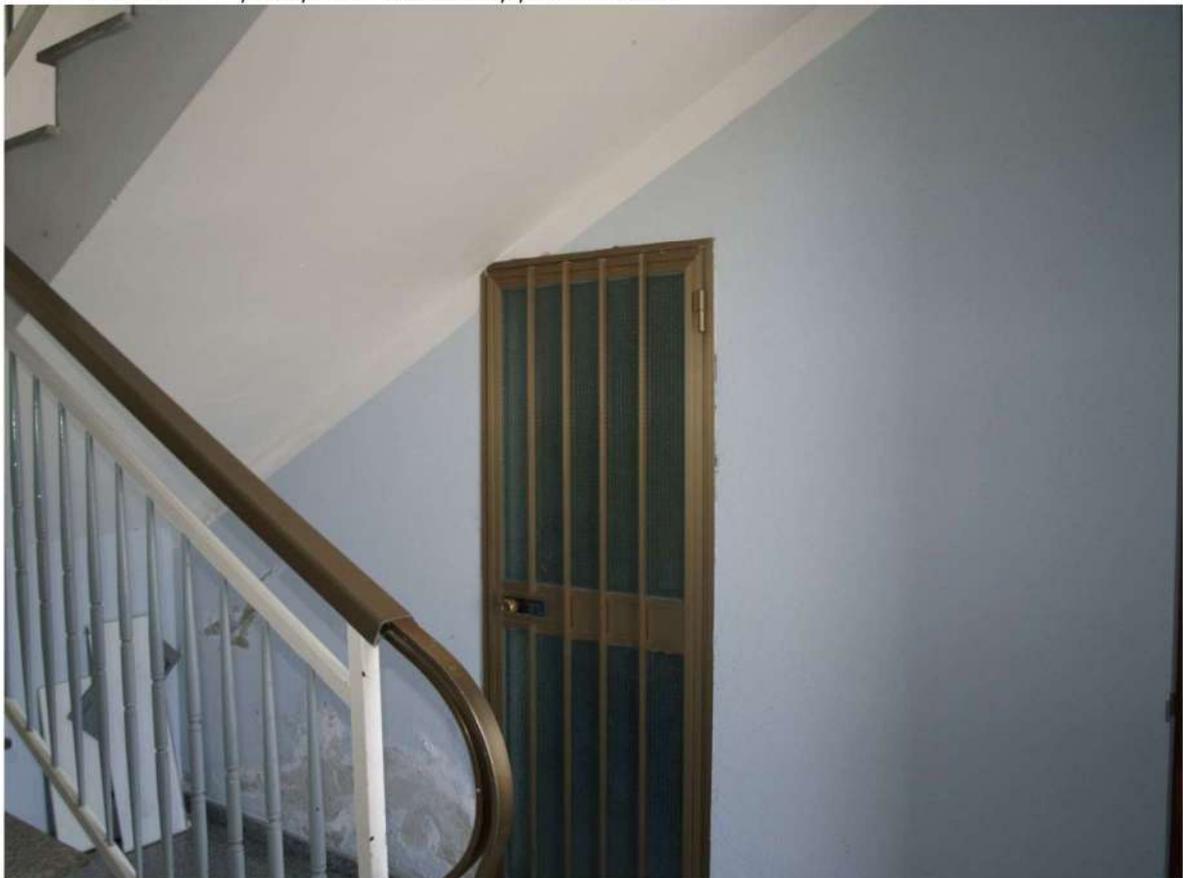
ingresso sottoscala all'Accessorio A2 al piano terra
